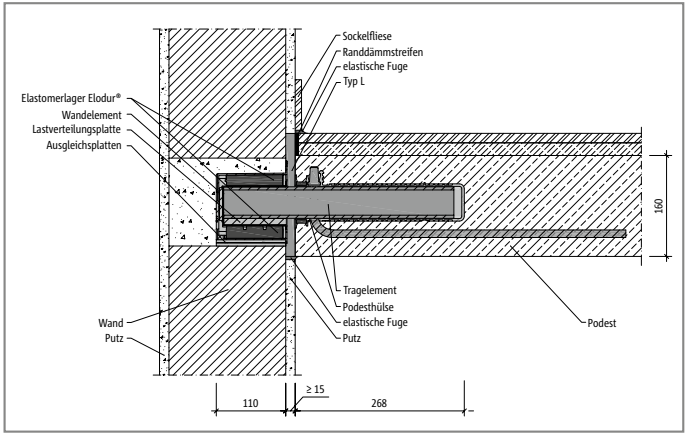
Schöck Tronsole® Typ P: mit Ortbetonpodest und Tronsole® Typ L
